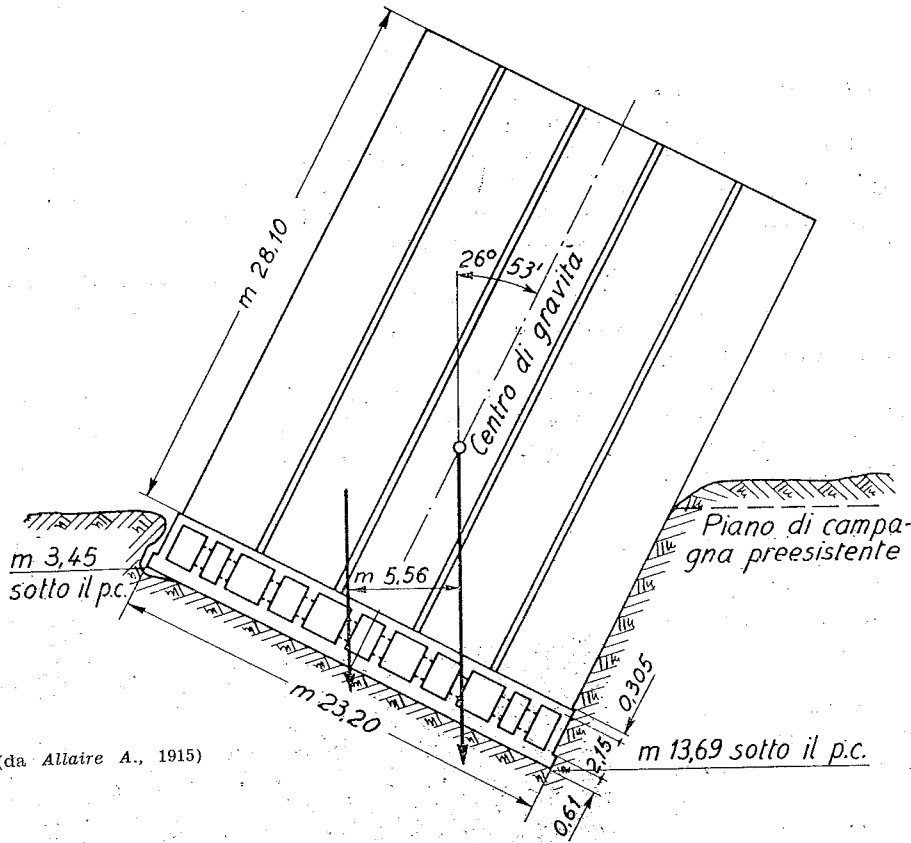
Sezione trasversale del silos dopo il dissesto.
